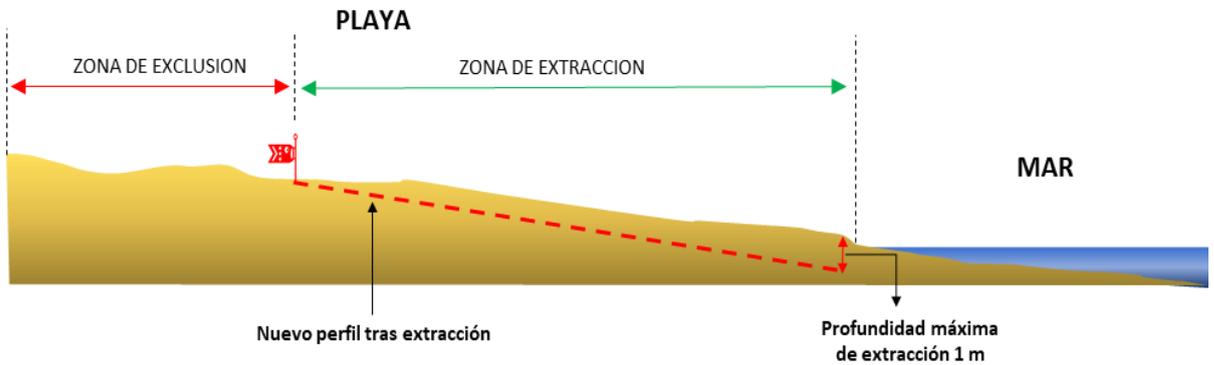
Características propuestas para los perfiles de playa en las zonas de extracción.
